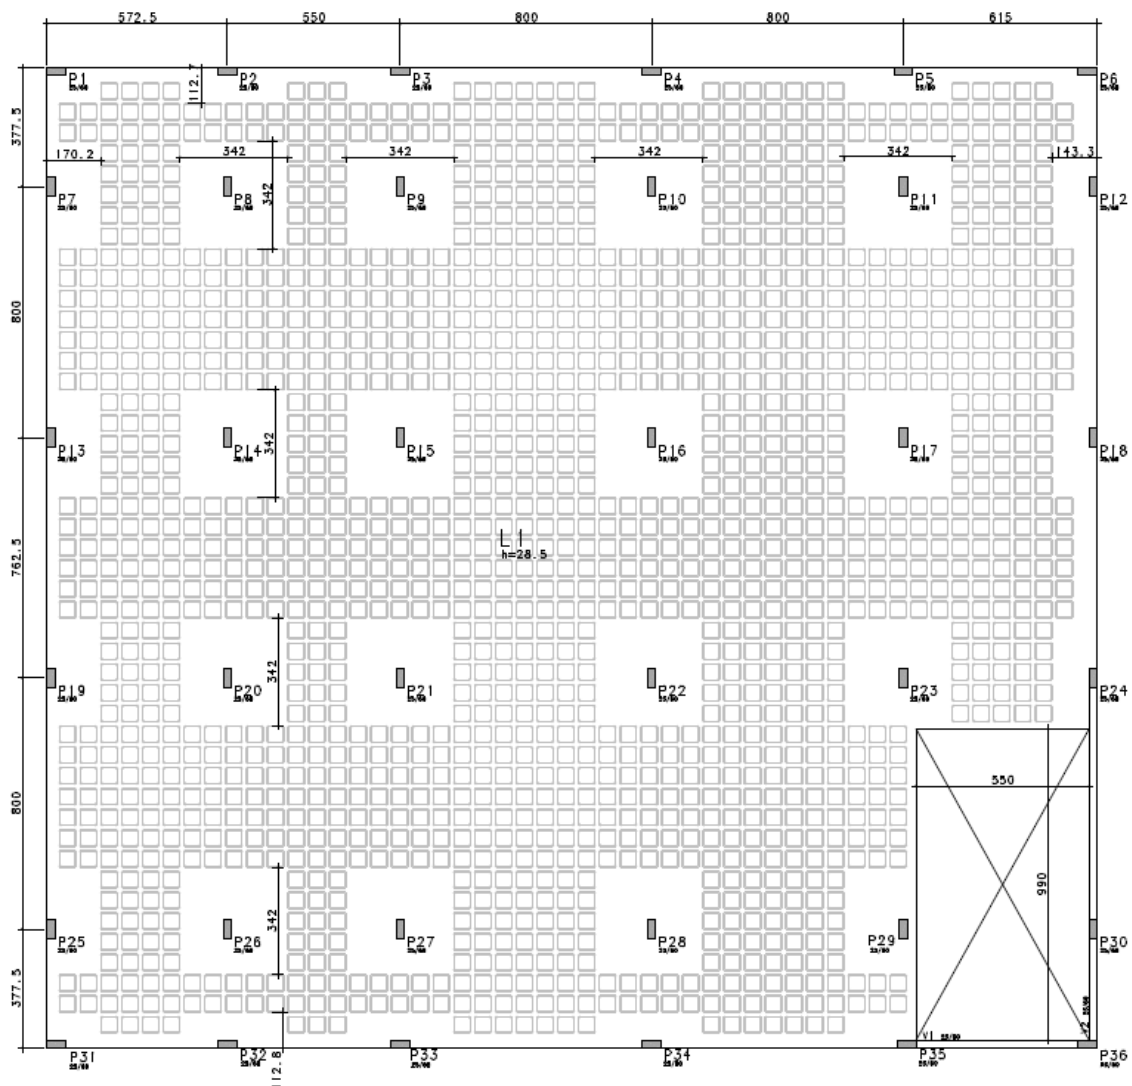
Projeto A1 - Planta de forma (dimensões em cm).
